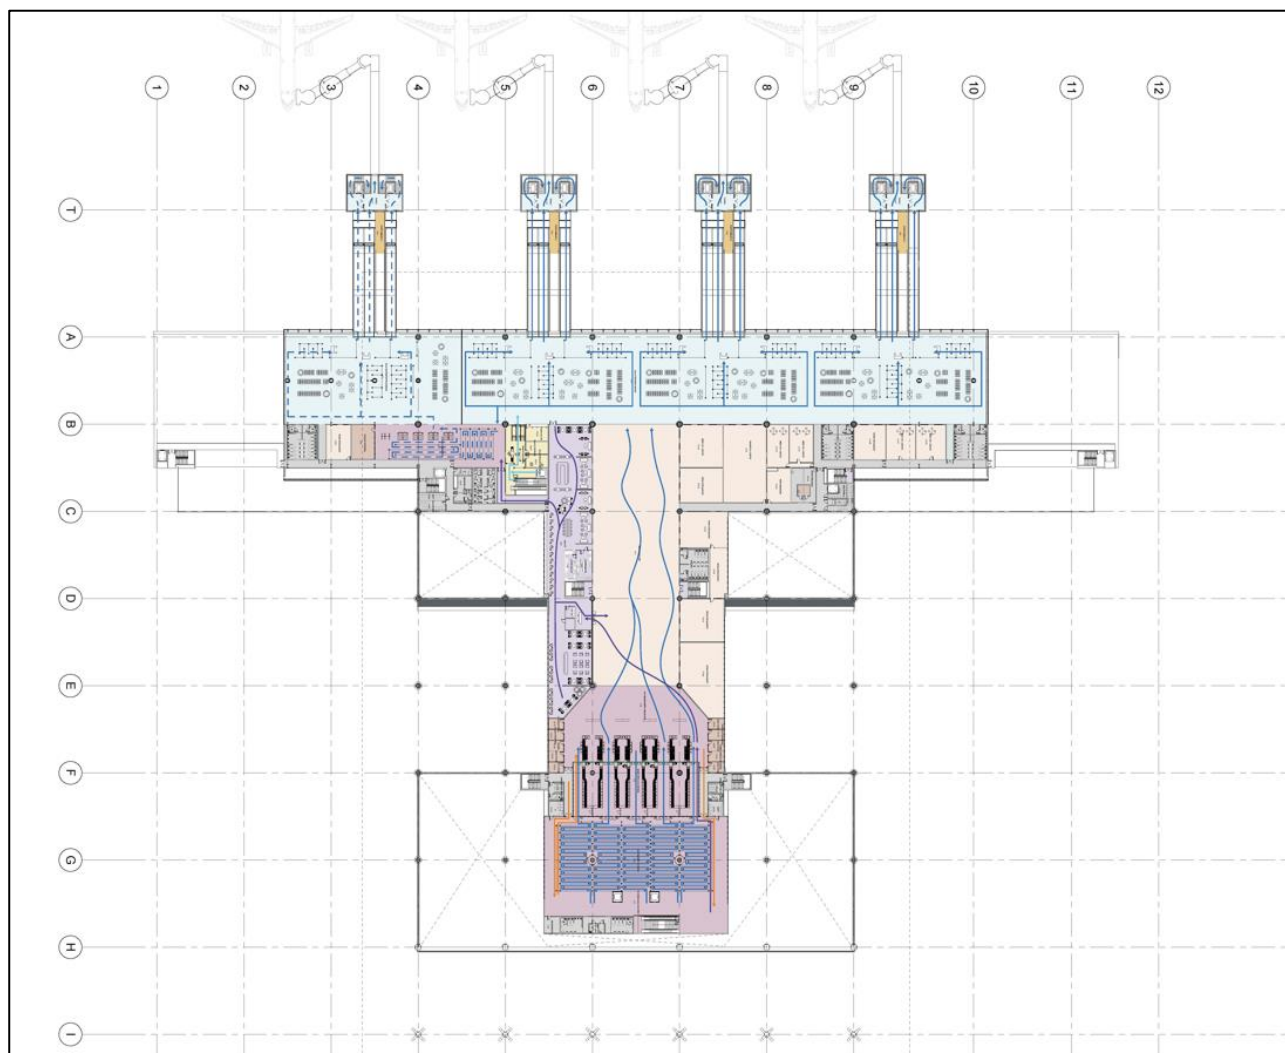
| Planimetria di flussi passeggeri del Primo Piano 2026.
